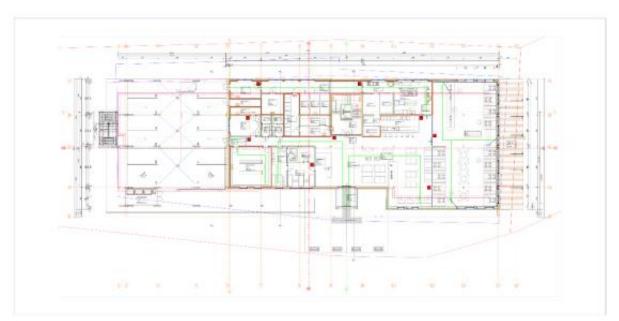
Grundriss Erdgeschoss (nicht maßstäblich)
